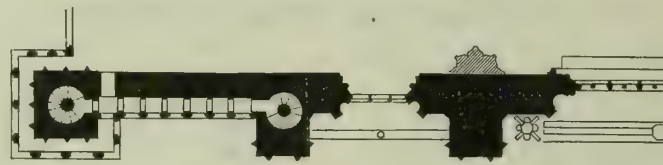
Grundriss in Obergeschosshöhe.
